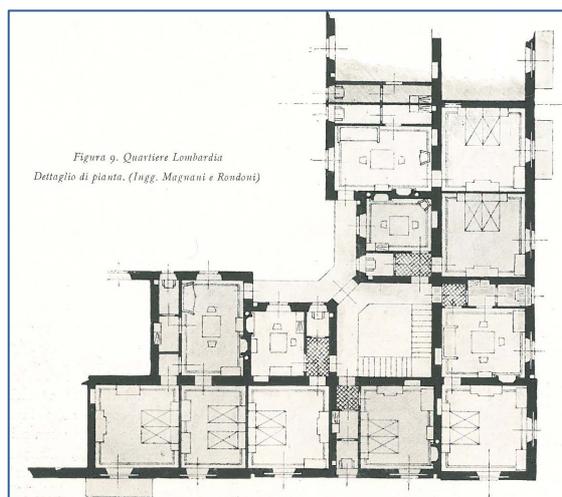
Quartiere Lombardia. Dettaglio pianta.
